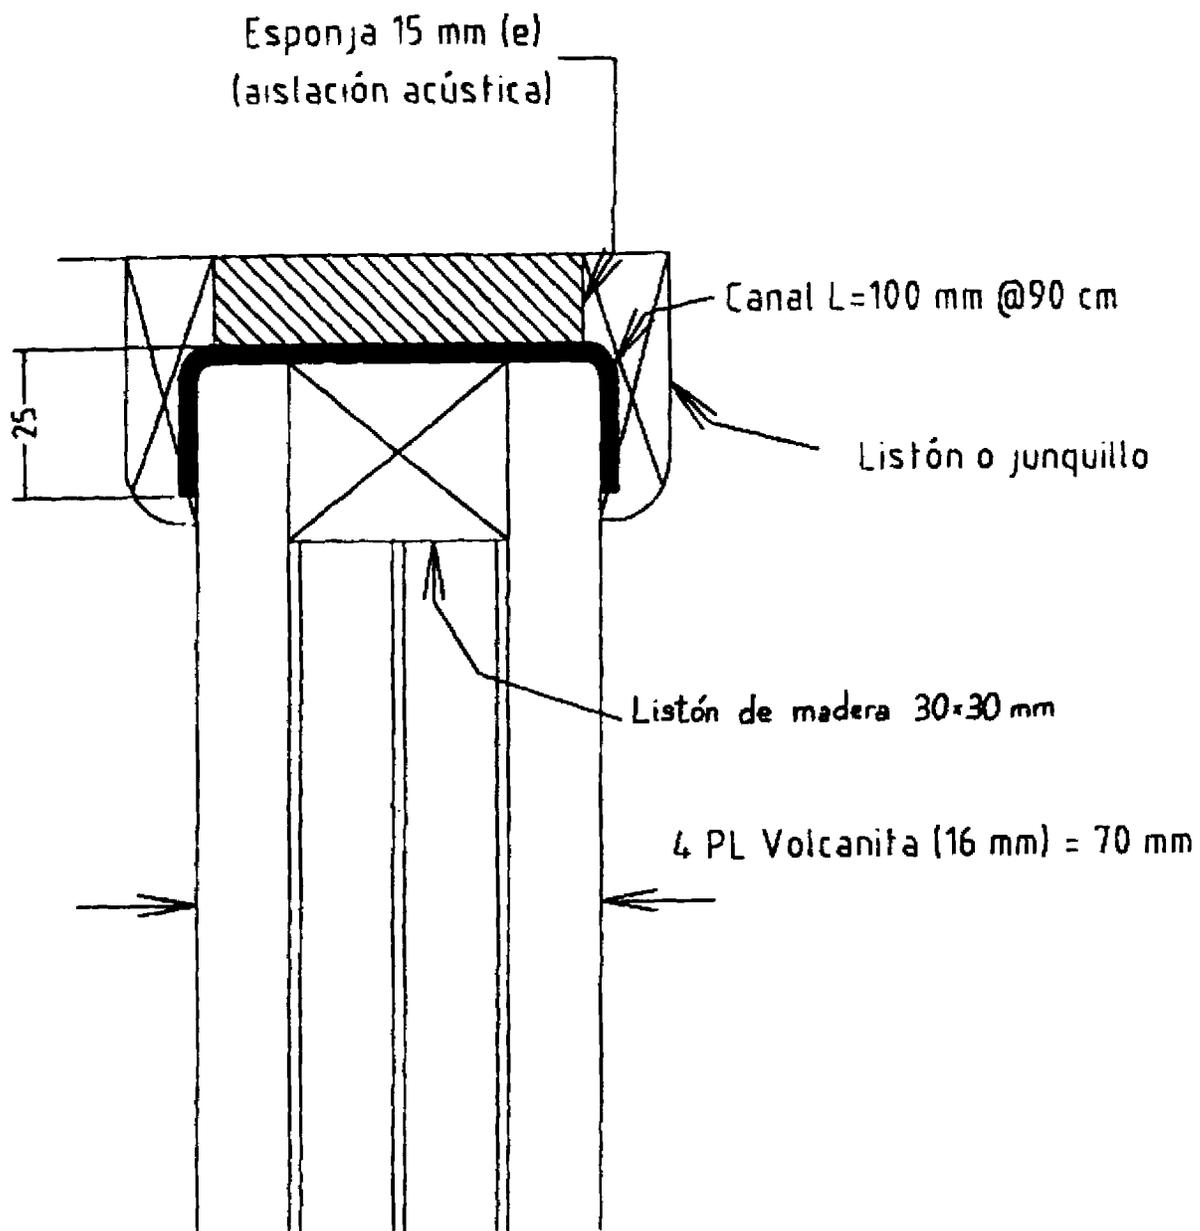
Detalle de apoyo superior de la Tabiquería Tipo 2.
